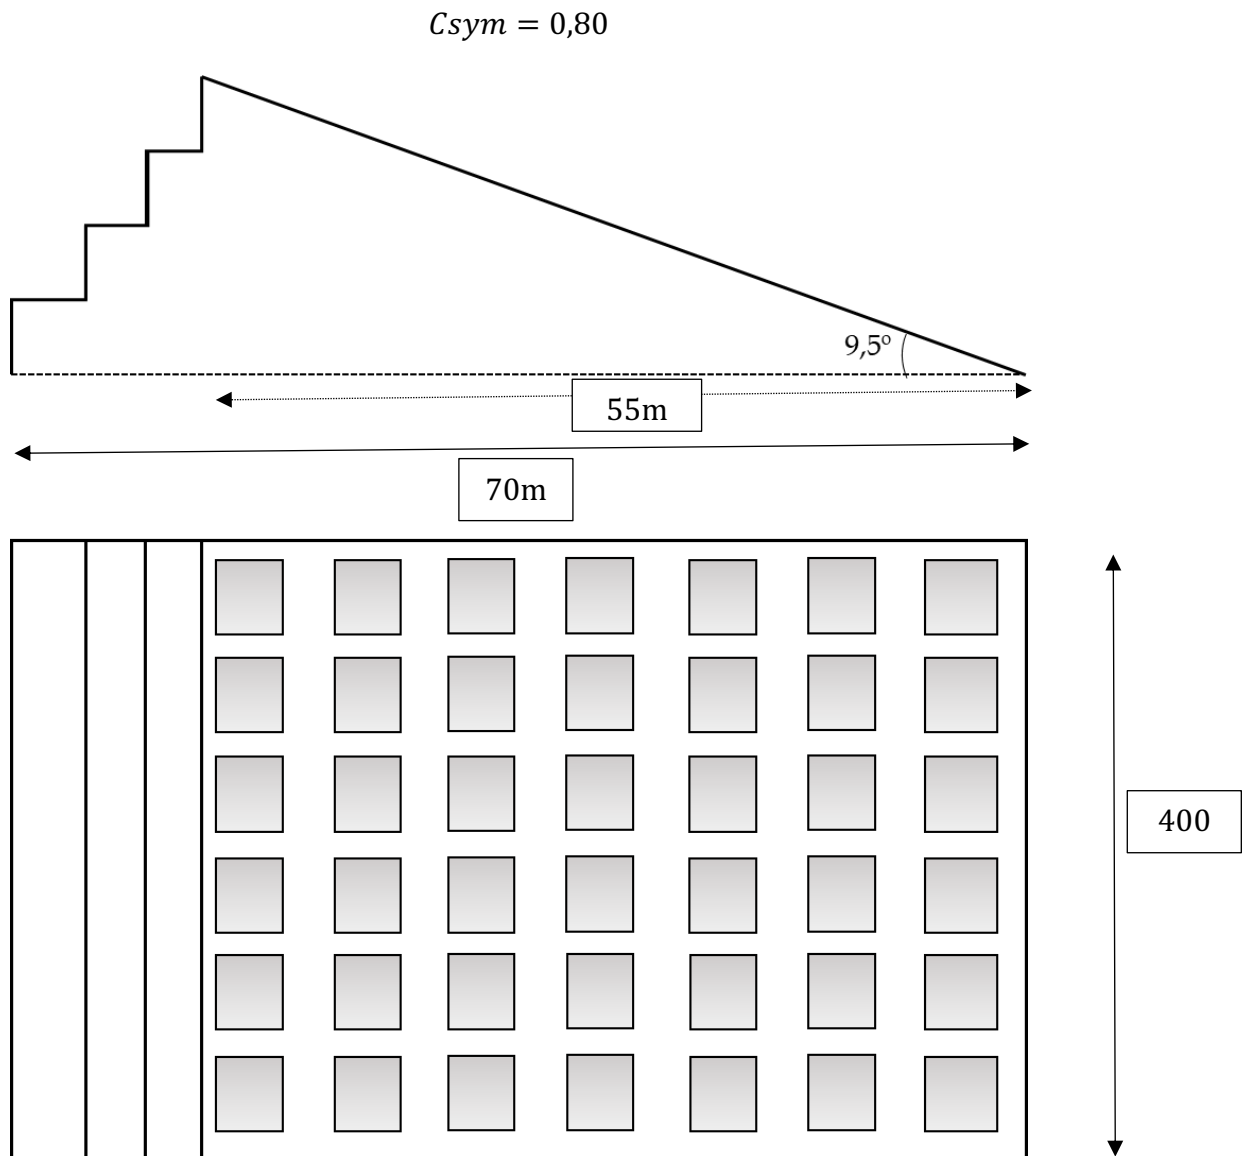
Disposición de las células fotovoltaicas en la cubierta de la planta.
